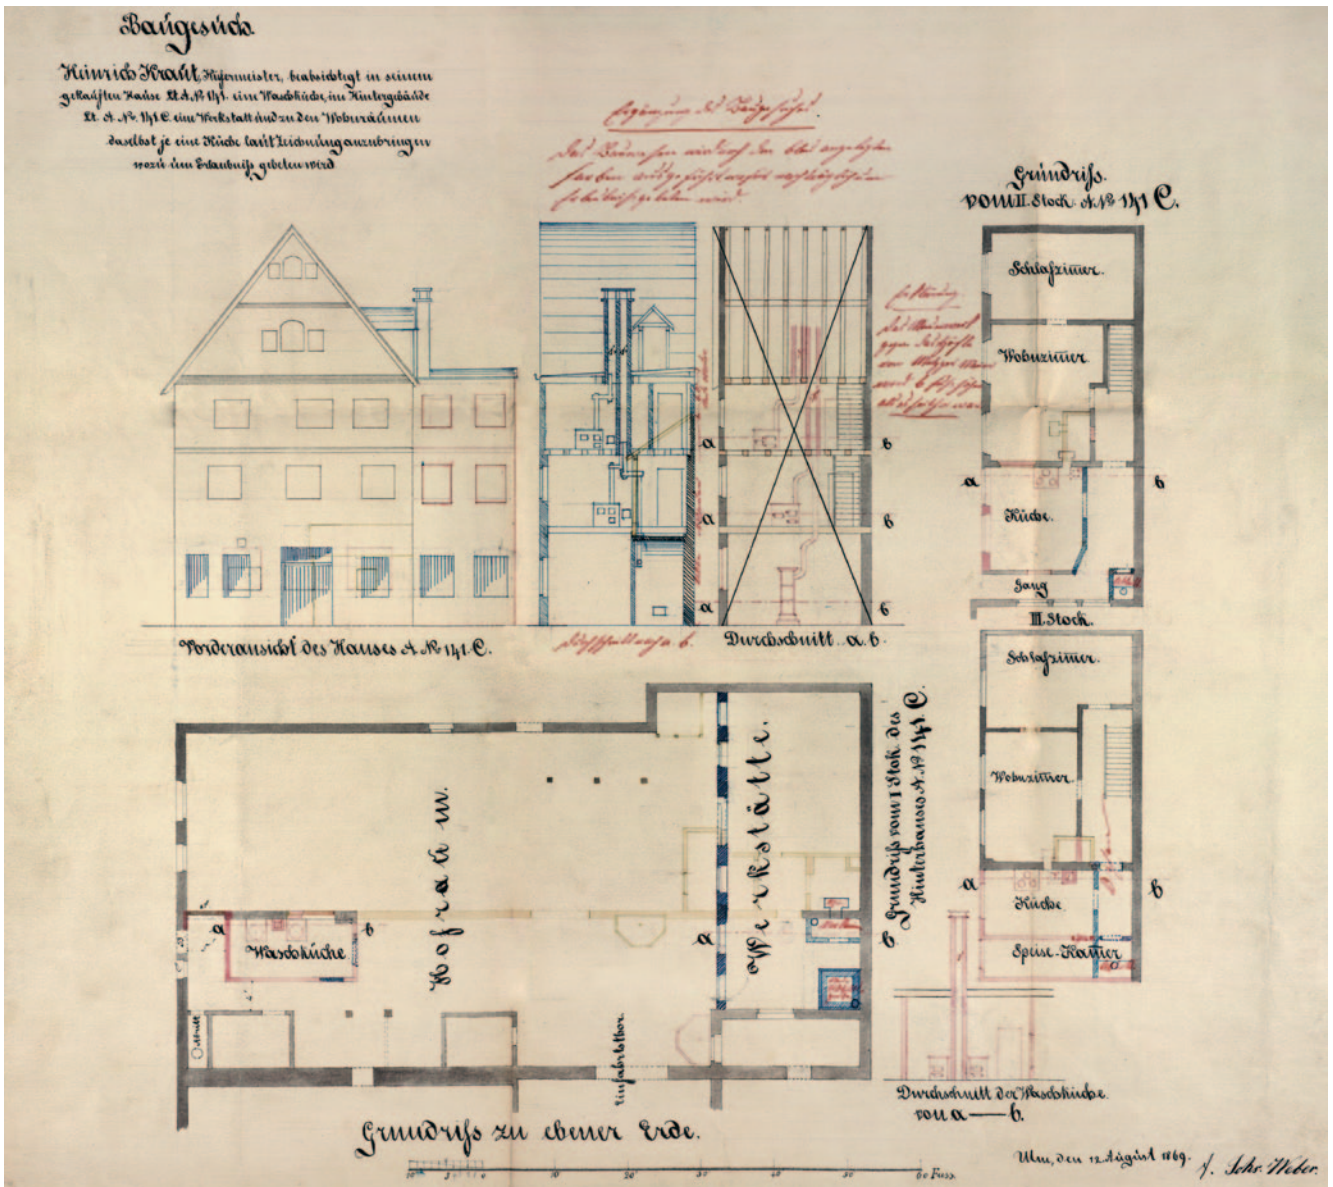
Gebäude Köpfingergasse 9 (A 141), Ansicht und Grundrisse des Hintergebäudes sowie Grundriss des Hofraumes, Baugesuch 1869.
